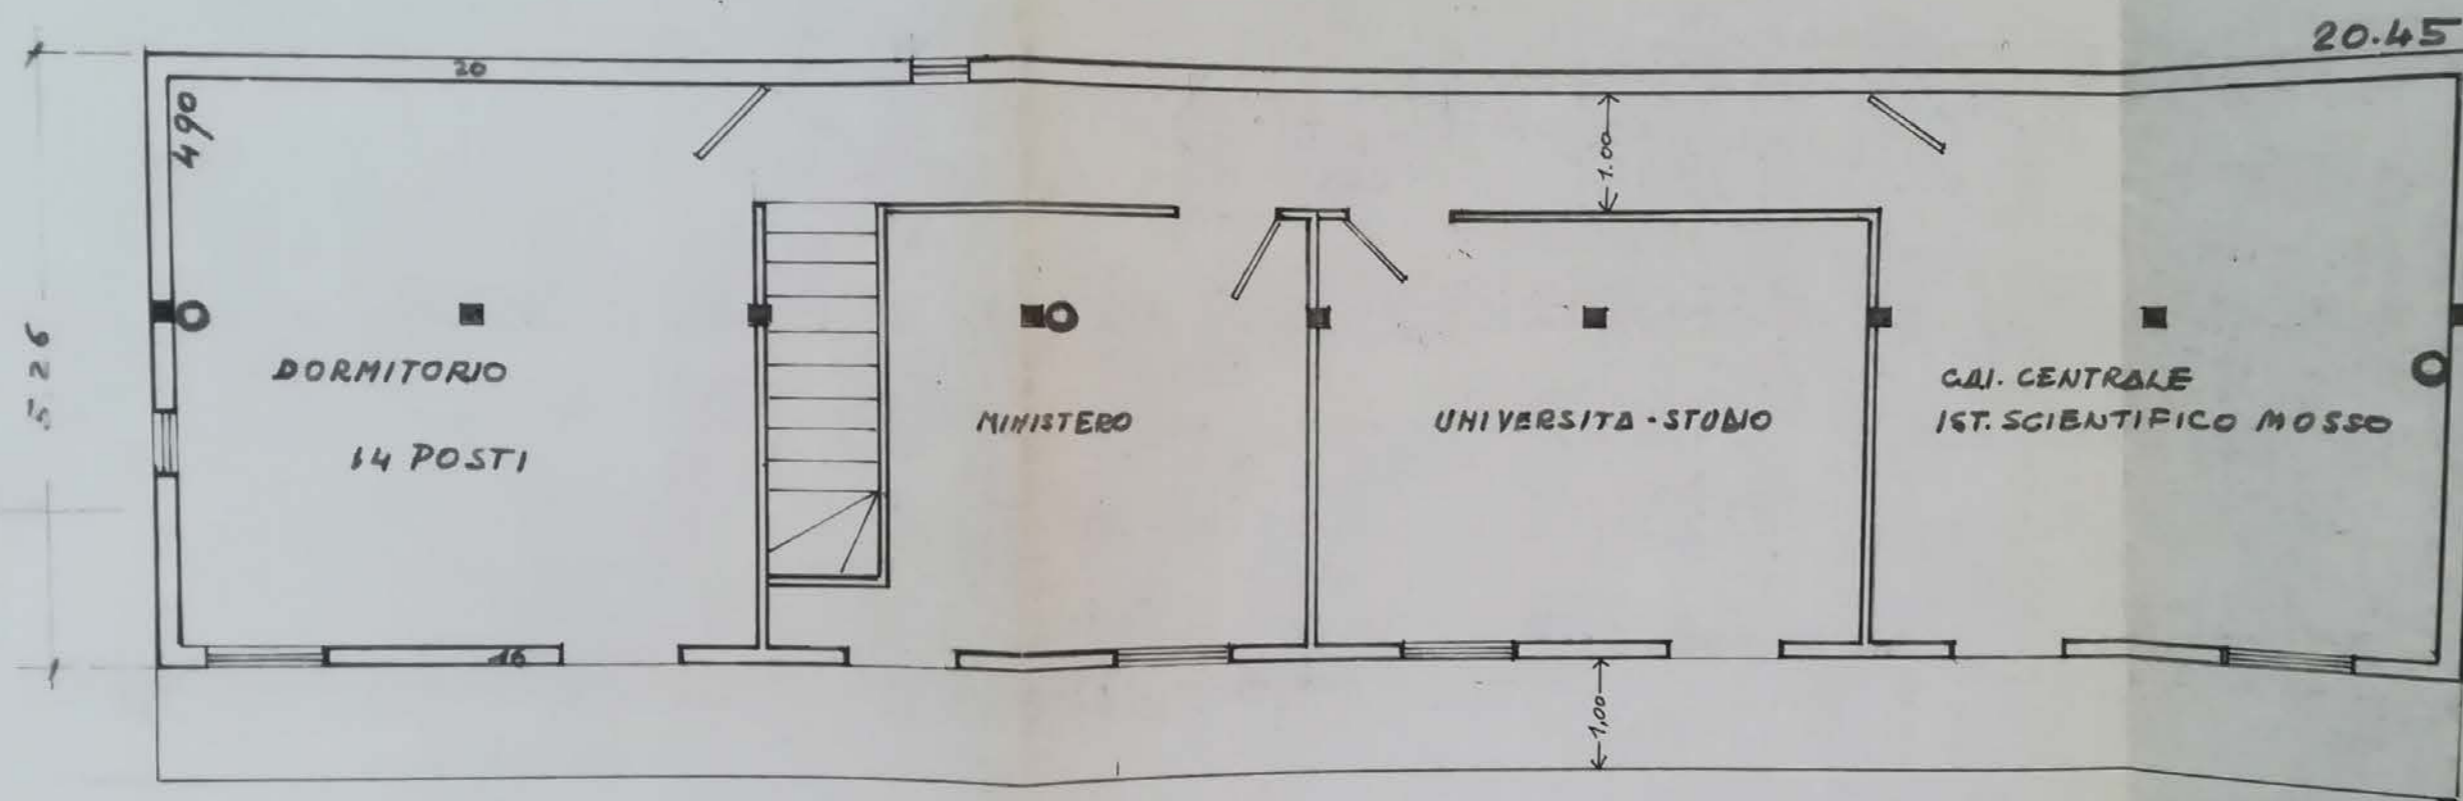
Pianta piano primo progetto originale del 1977 redatto dallo studio del geometra Carlo Milone.
